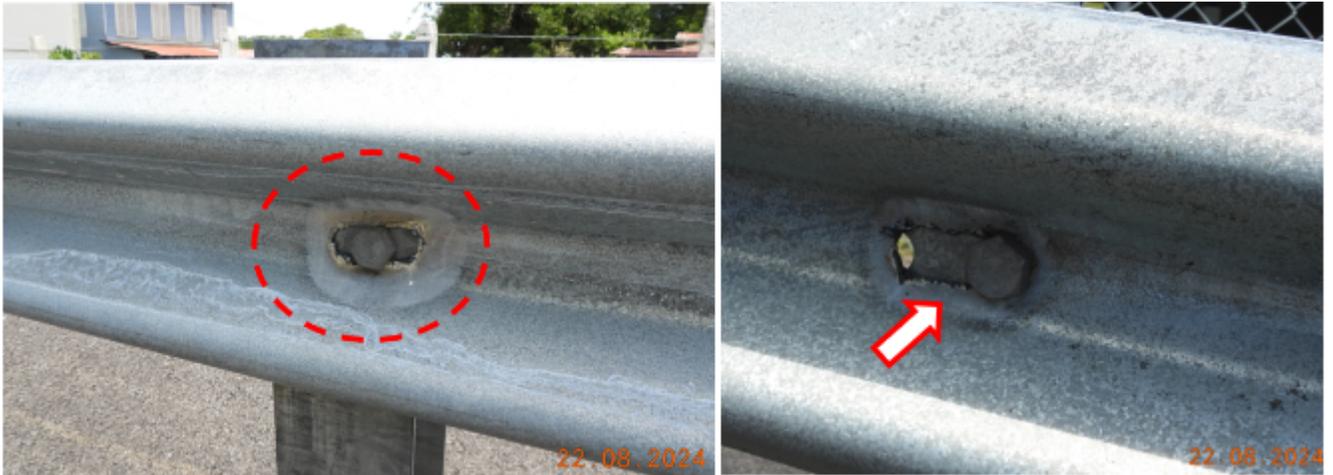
Cortes en las vigas de las barandas para introducir tornillos.
